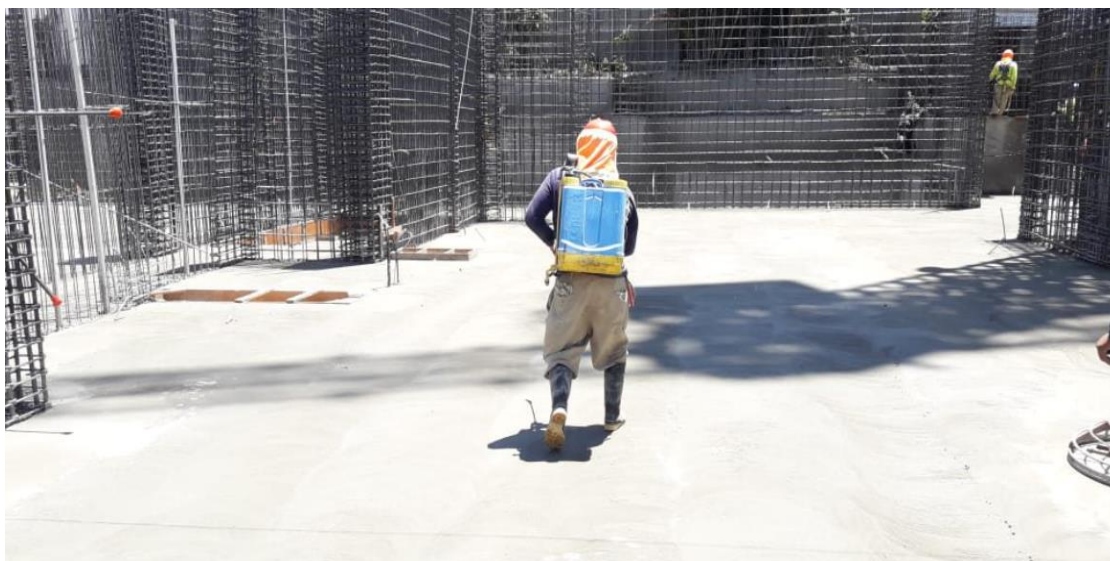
Aplicación de curador químico para concreto en proyecto Torre Las Loras
